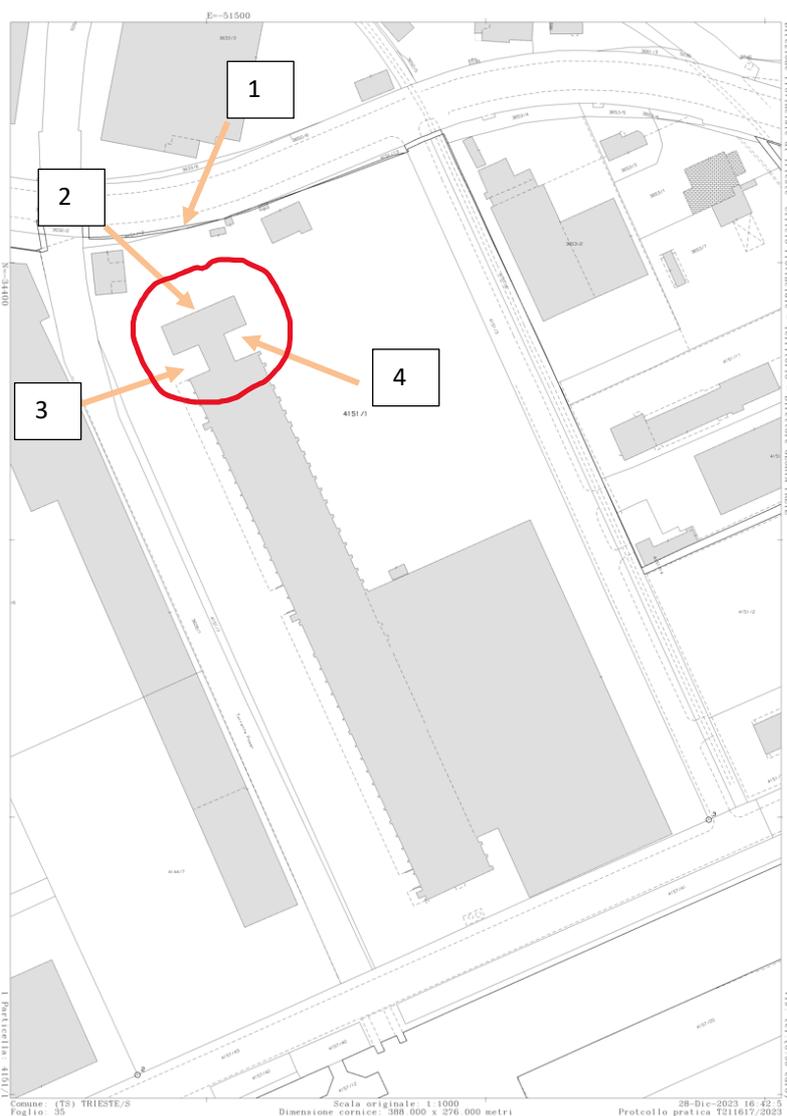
Vista aerea dell'area d'intervento. Edificio Via Caboto 27 Trieste.
